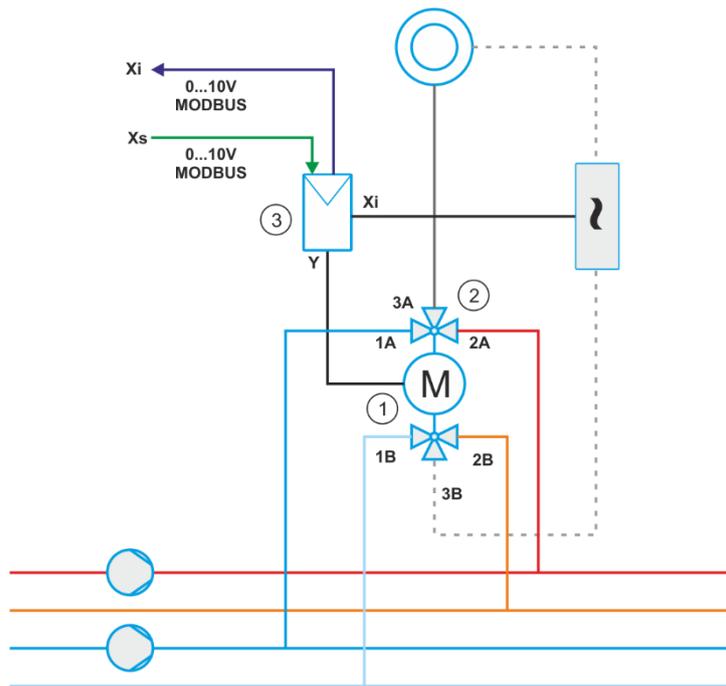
Application typique de chauffage et de refroidissement à 6 ports pour poutres froides
